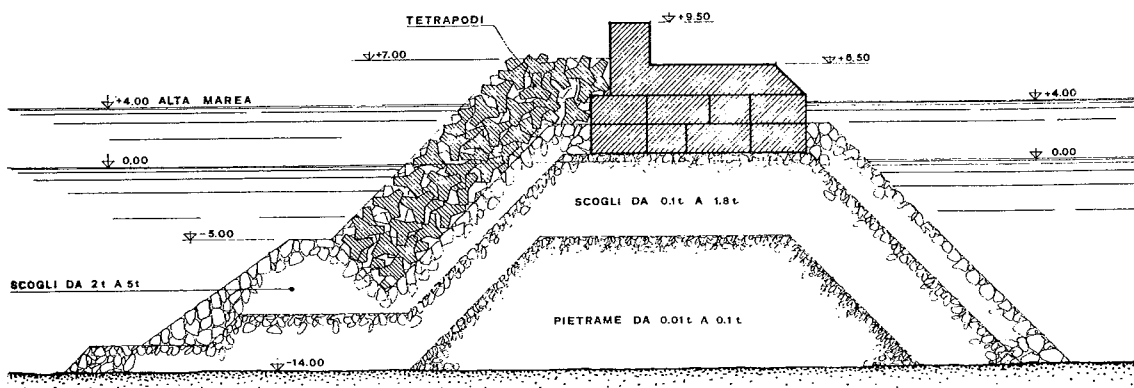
Sezione diga a gettata a strati sovrapposti.
